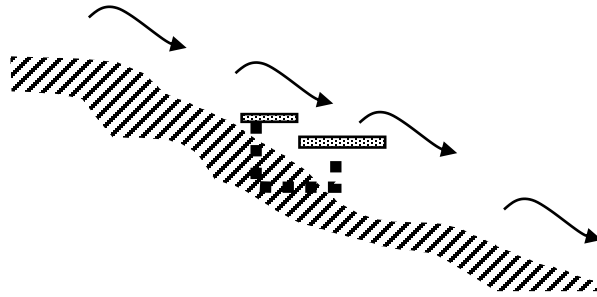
esquema de cubierta verde Fuente: Elaboración propia
